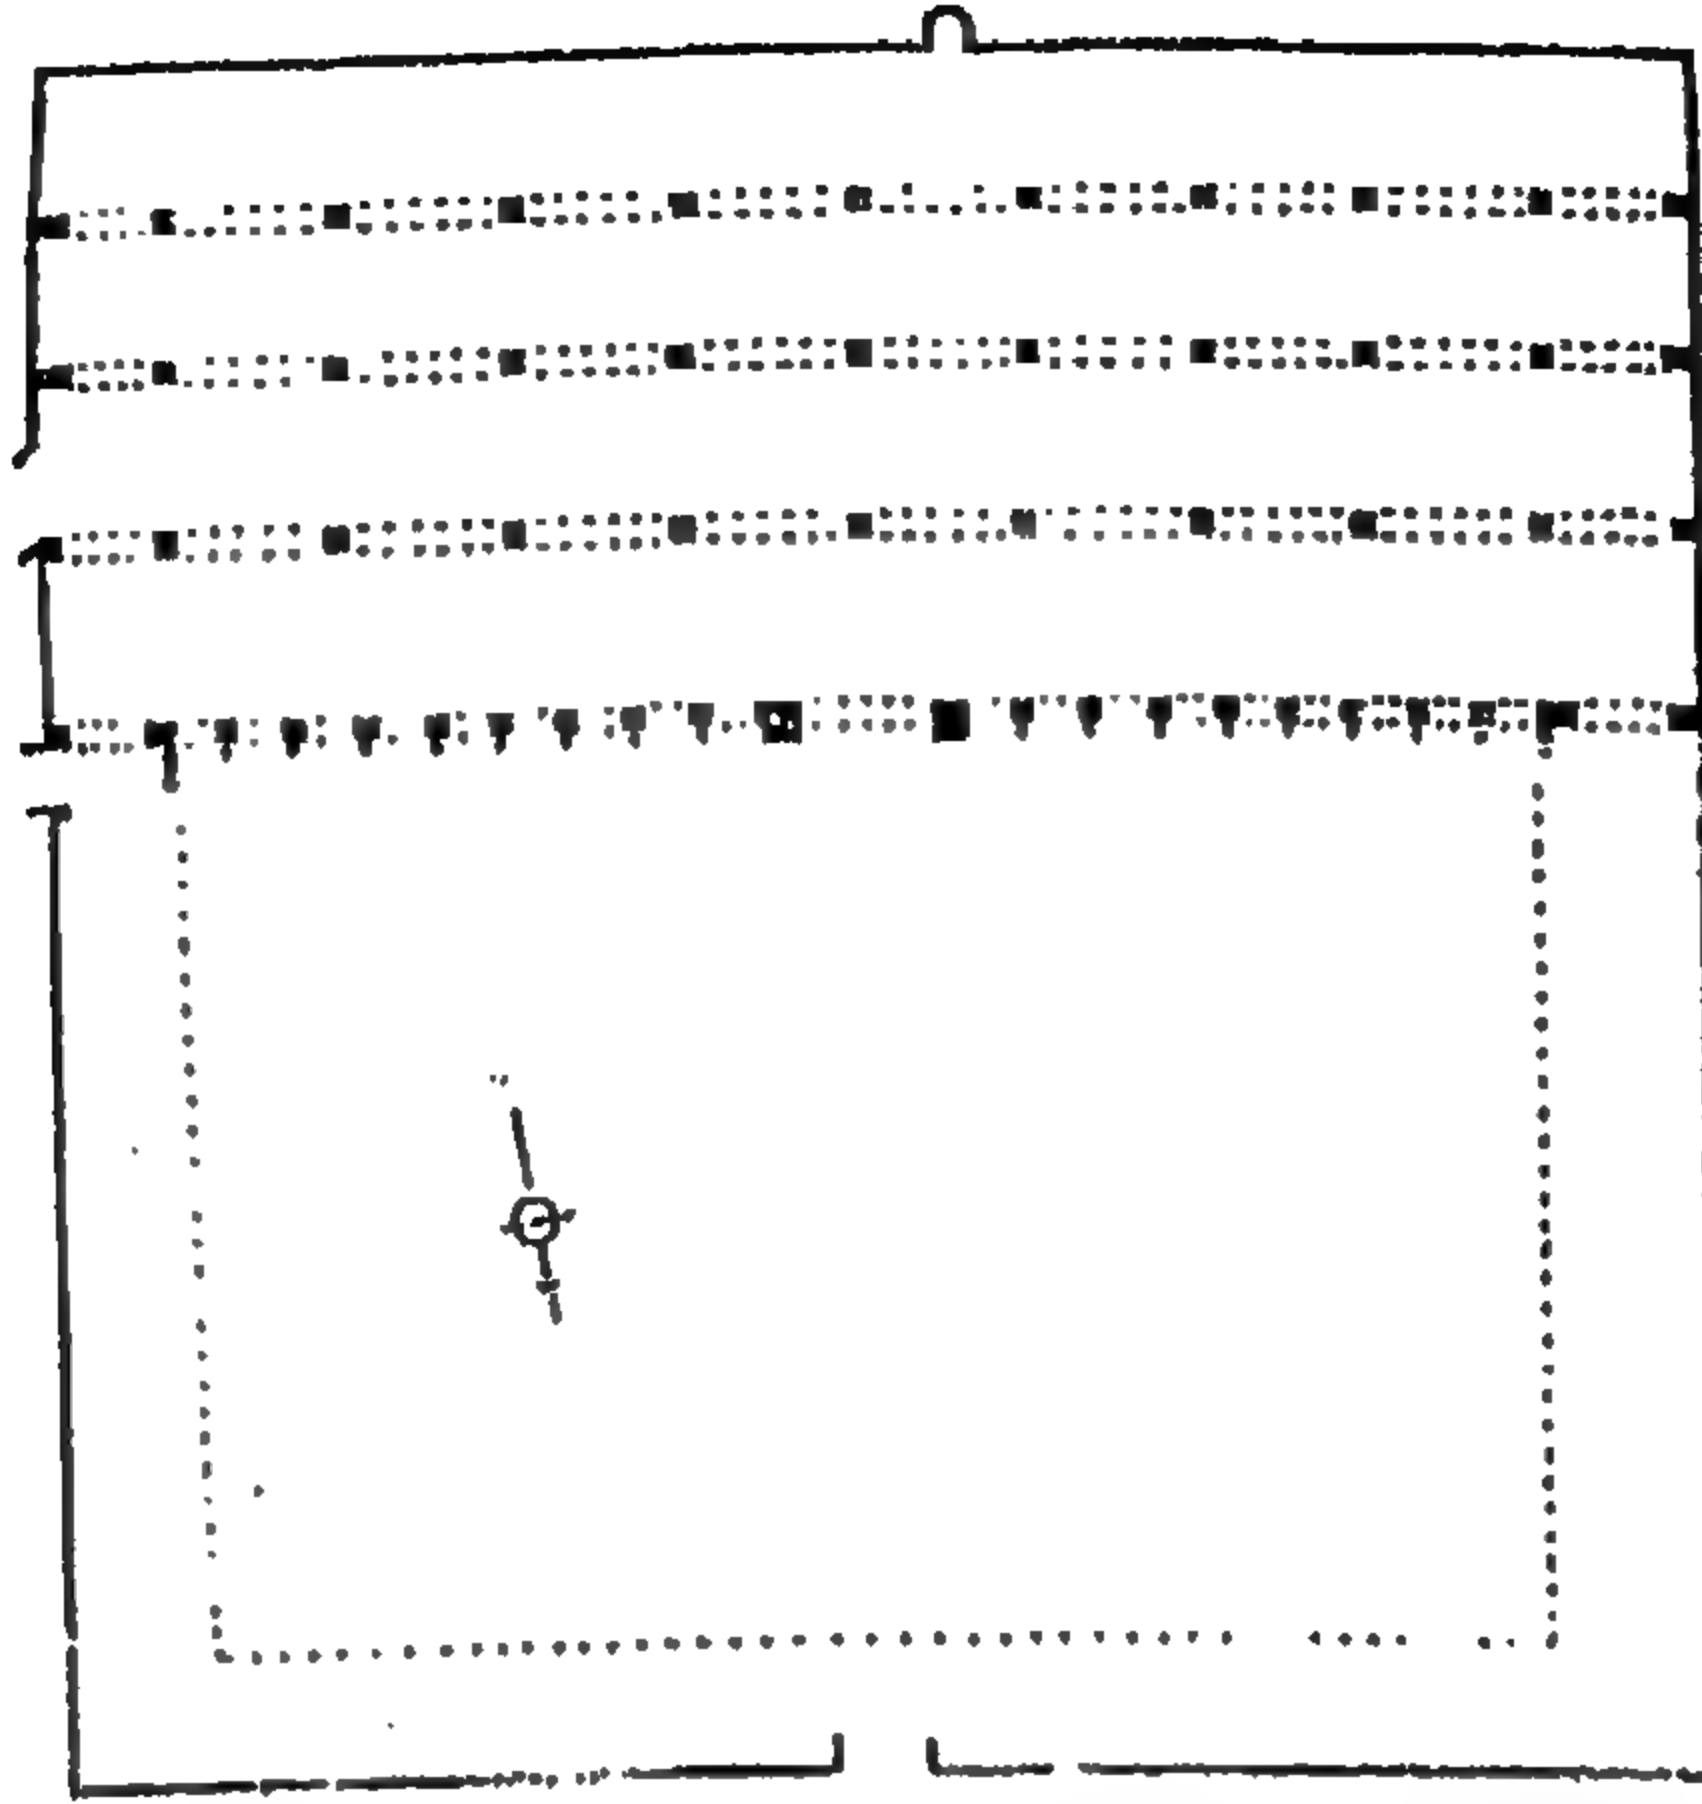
مسقط أفقي للجامع الأزهر في مرحلة إنشائه الأولى (عن : Hong)
